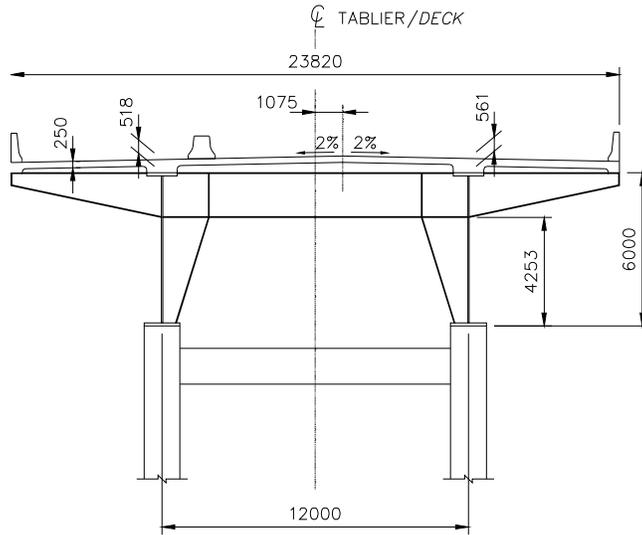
Coupe transversale – Pont en ossature mixte avec des piles en V – bipoutre
